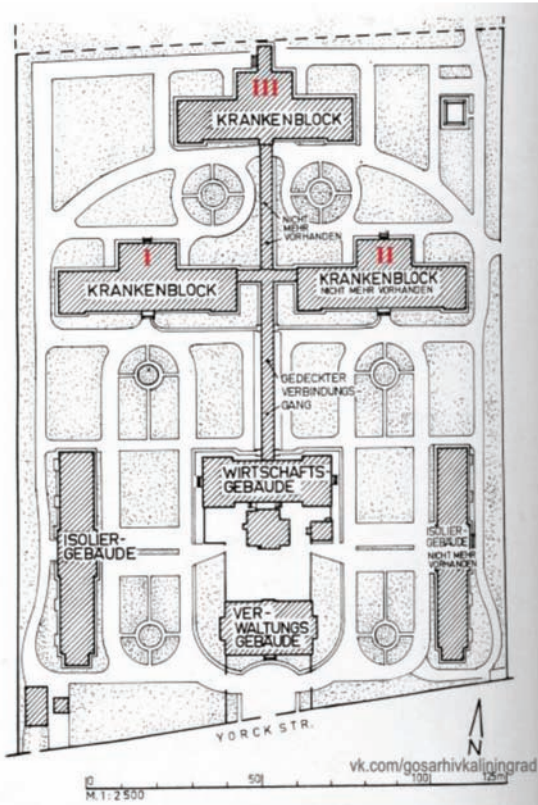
Общий план-схема расположения корпусов гарнизонного лазарета «Йорк» (I, II, III — лечебные корпуса лазарета), 1879 г. [3]
